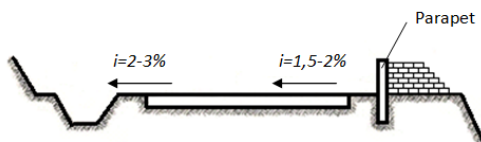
Profil transversal al drumului cu panta transversală într-o singură parte
